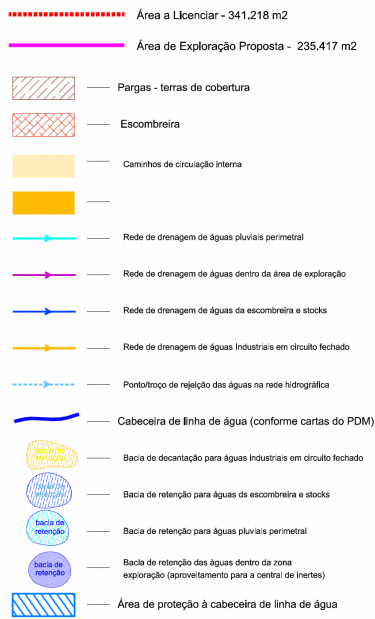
Extrato da planta N2-1 Rede de Drenagem Interna (Plano de Pedreira).
